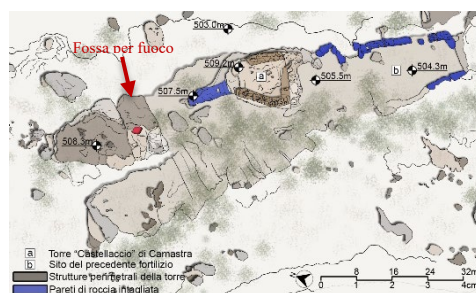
Rilievo fotogrammetrico, planimetria del sito del Castellaccio (Tito Vaccaro, 2024)
